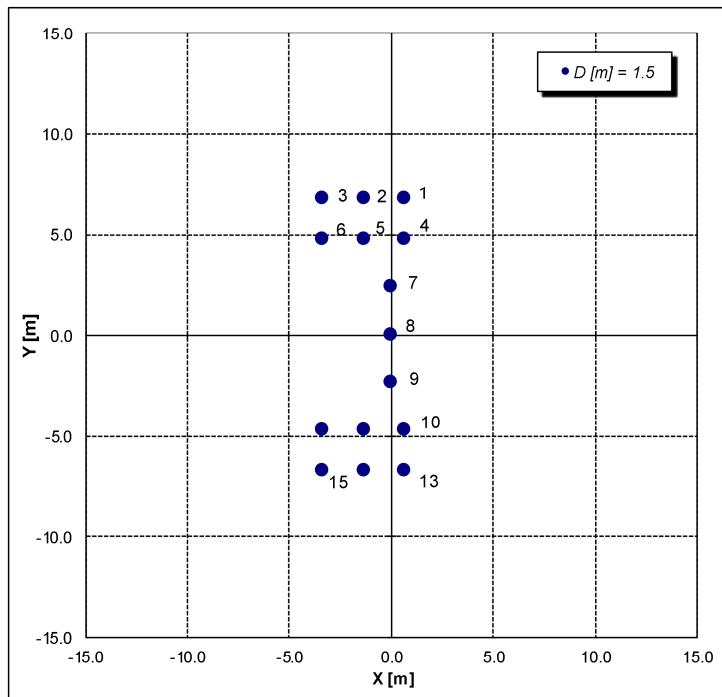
fondazione spalla di varo (15 pali)
